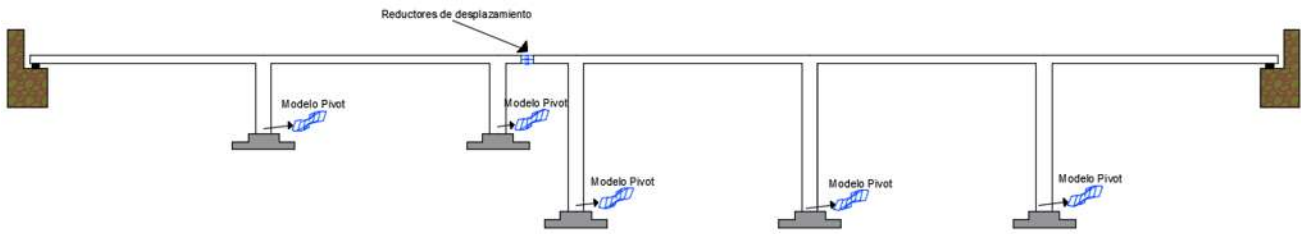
Muestra la colocación del modelo Pivot en las pilas de puente
